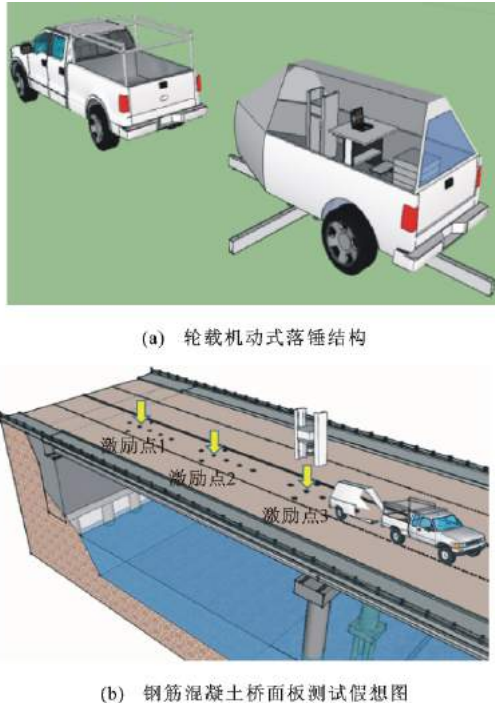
轮载机动式落锤测试钢筋混凝土桥面板假想图
